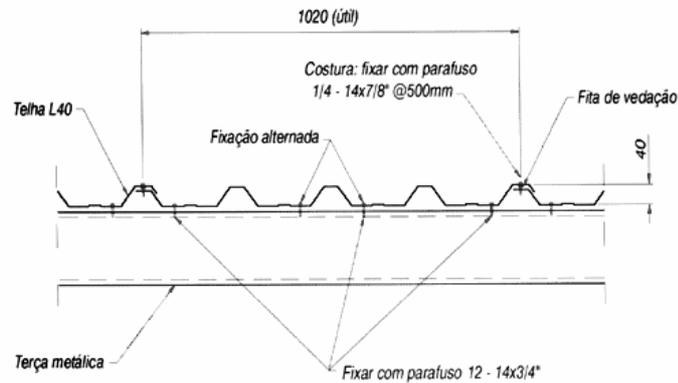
Montagem das telhas (METÁLICA,1999)
